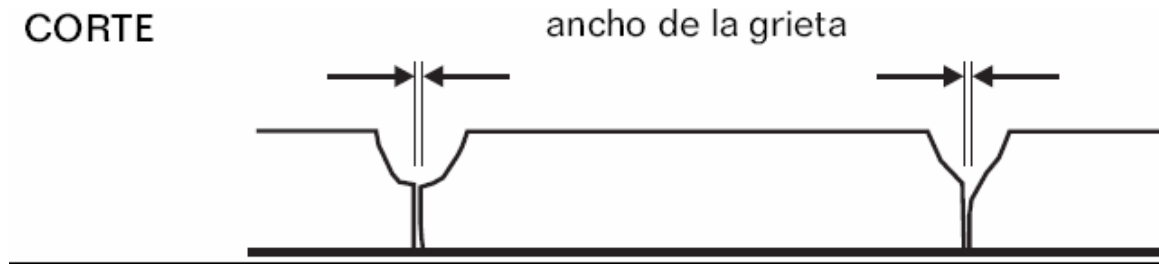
Corte transversal de una losa, mostrando el ancho de una grieta
